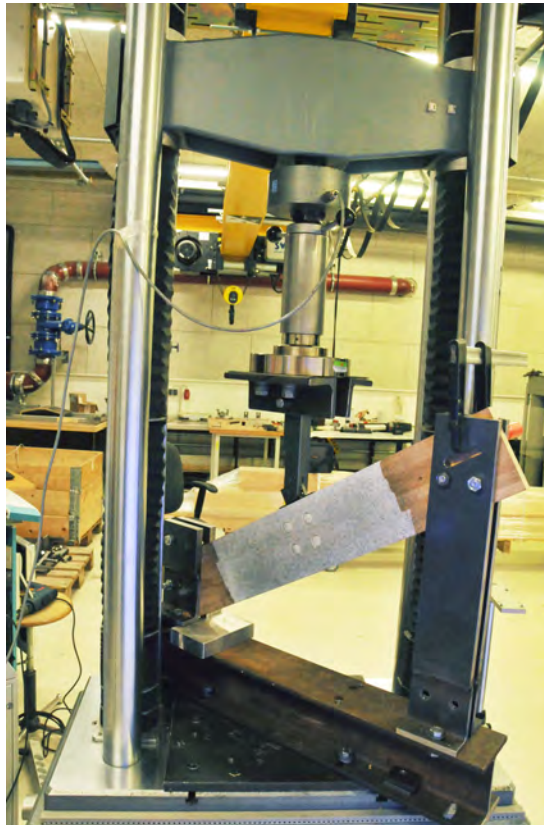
Versuchsaufbau - Geschossdeckenanschluss
